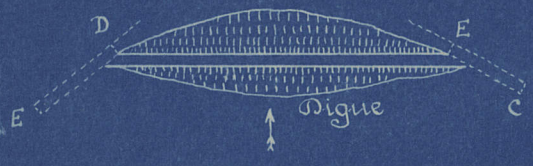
Digue d'Aubert a) Coupe du couronnement.
